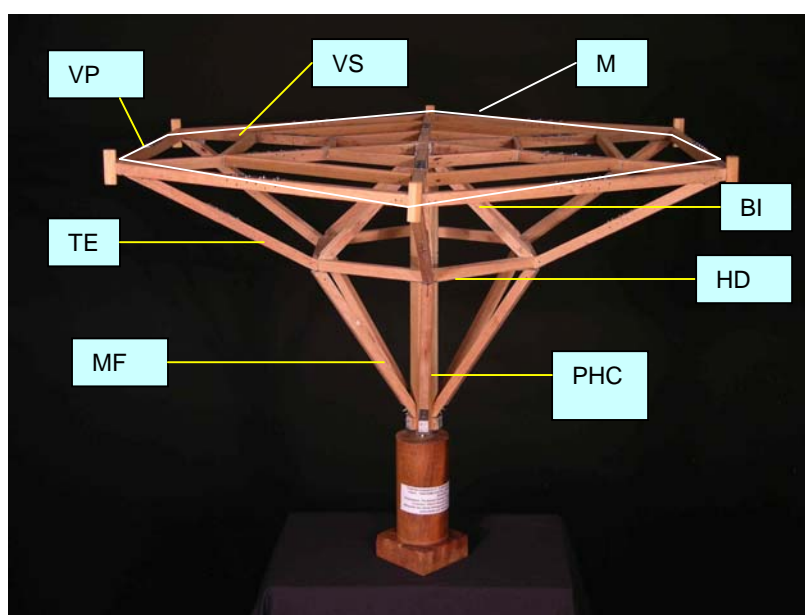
102 – Maquete na escala 1:10 da célula hexagonal modular (CHM) composta por: (M) módulo=plano de laje da (CHM); (PHC) pilar hexagonal central ; (VP) viga principal; (VS) viga secundária; (MF) mão francesa; (BI) barra inclinada, (TE) treliça espacial, (HD) hexágono do diamante
